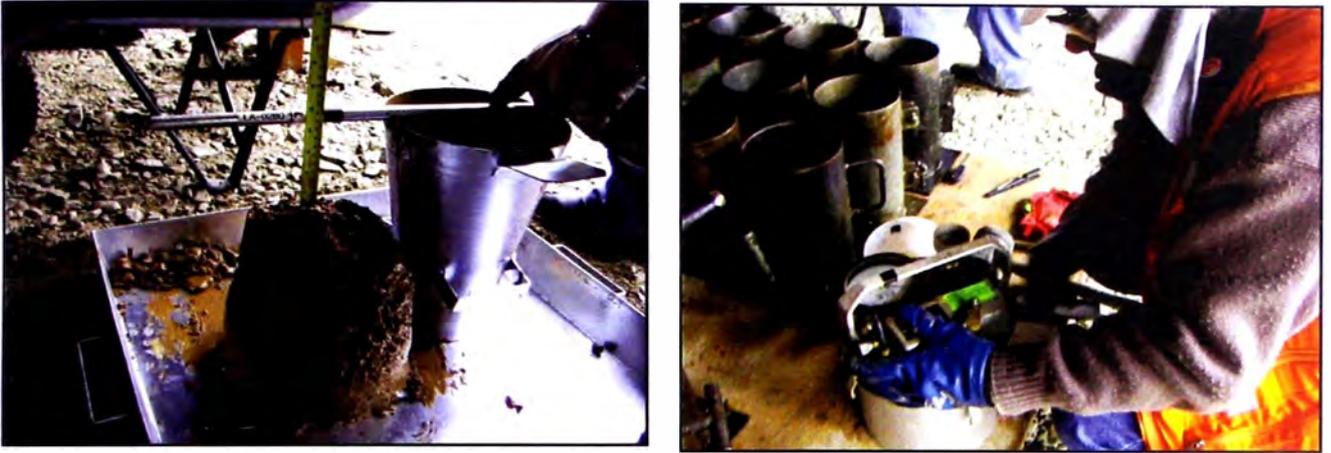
Principales ensayos al concreto en estado fresco (Fuente: Archivo propio)
